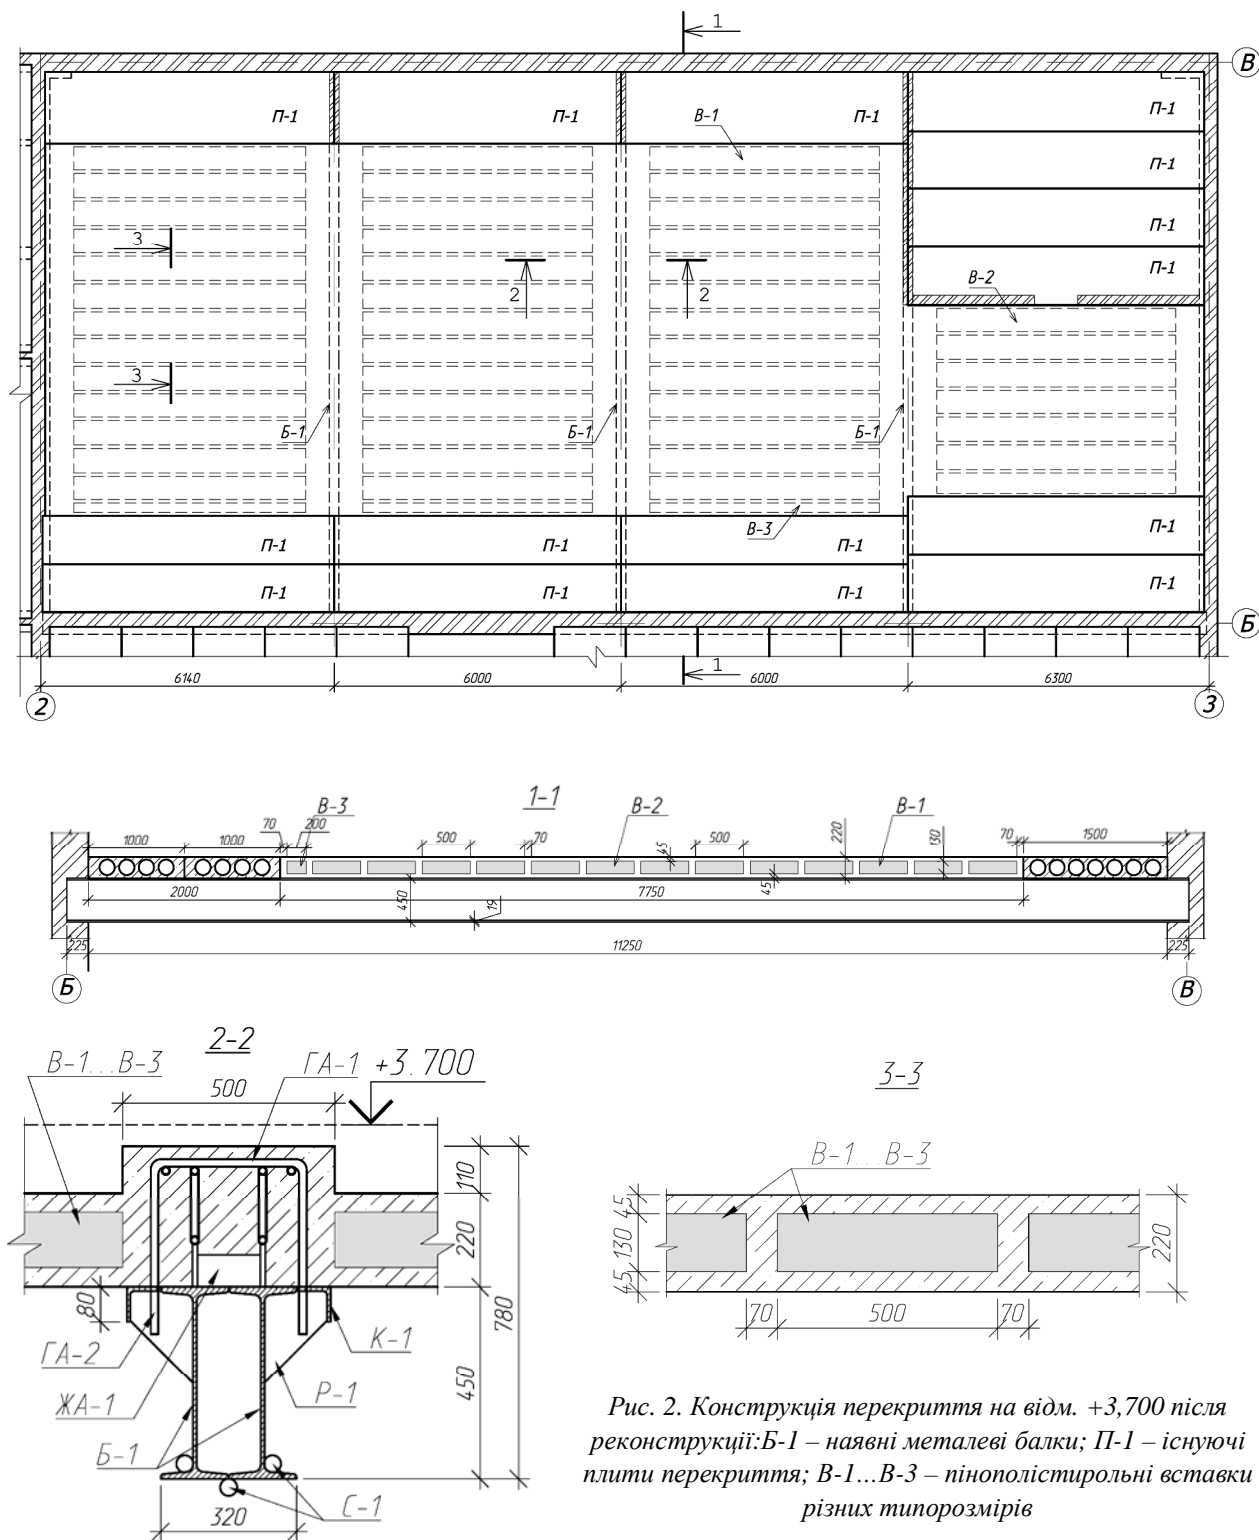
Конструкція перекриття на відм. +3,700 після реконструкції: Б-1 – наявні металеві балки; П-1 – існуючі плити перекриття; В-1...В-3 – пінополістирольні вставки різних типорозмірів
